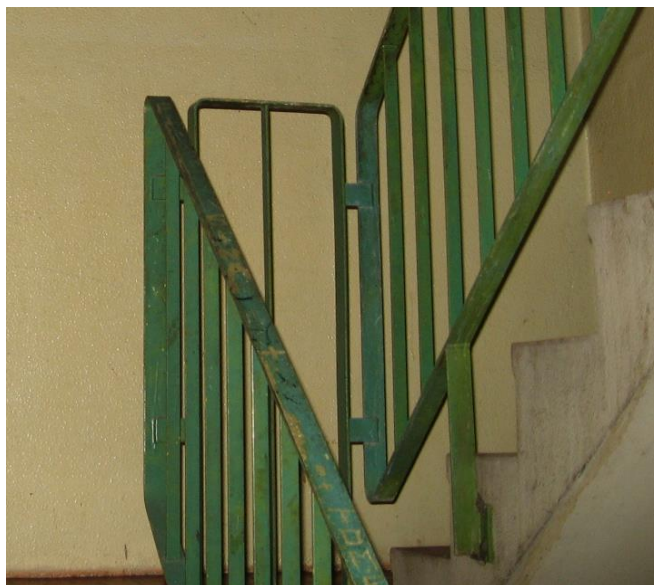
Exemplos de degradação de guardas metálicas em zona de circulação comum, Bairro de São Gonçalo
